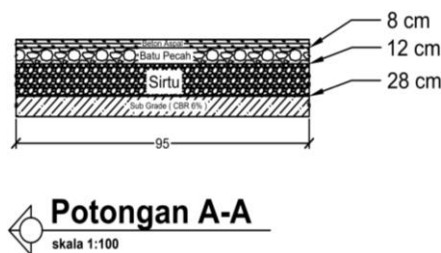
Detail Lapisan Struktur Perkerasan Perencanaan (cm)
